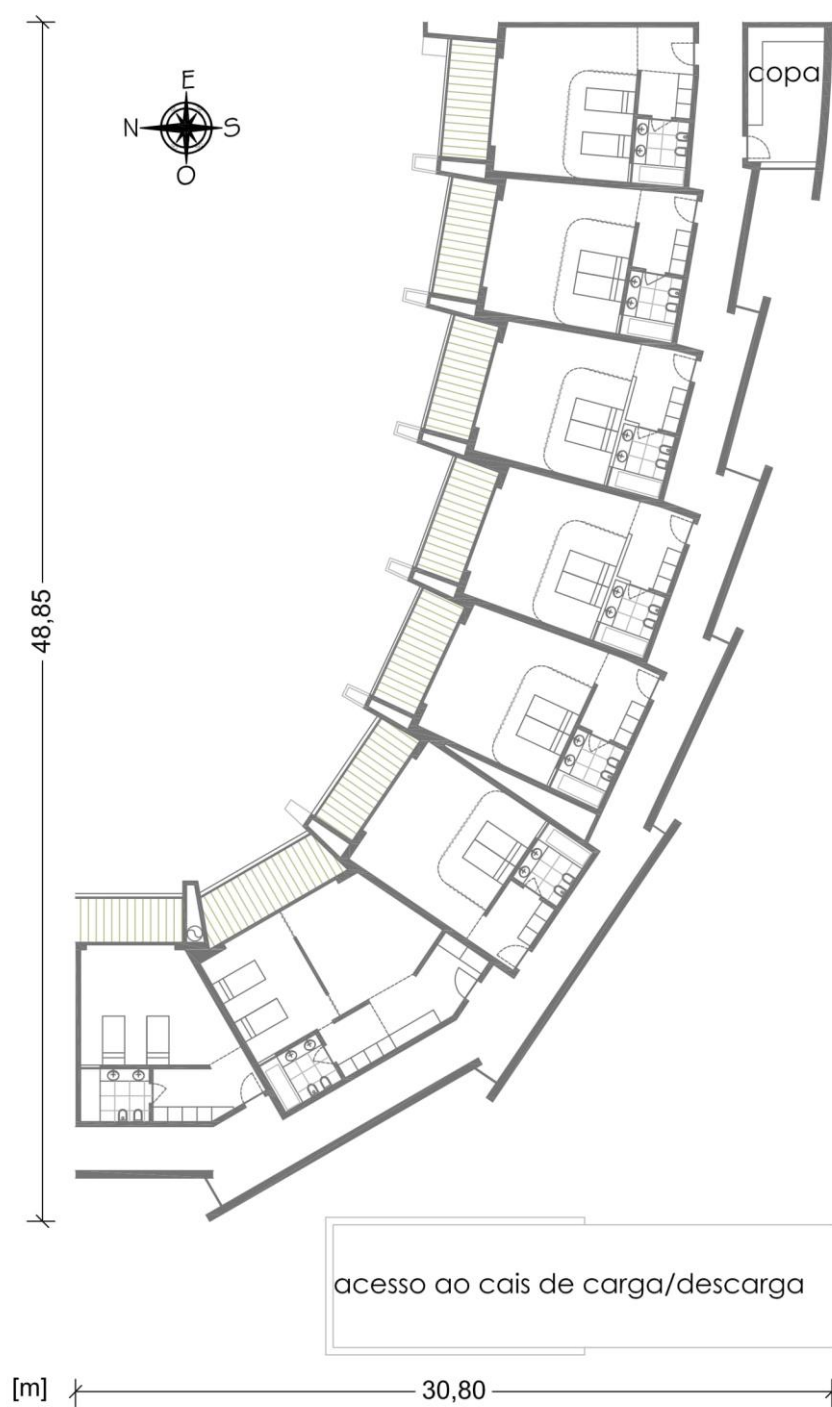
Planta Arquitetónica do Piso 1: corpo F (s/escala).
